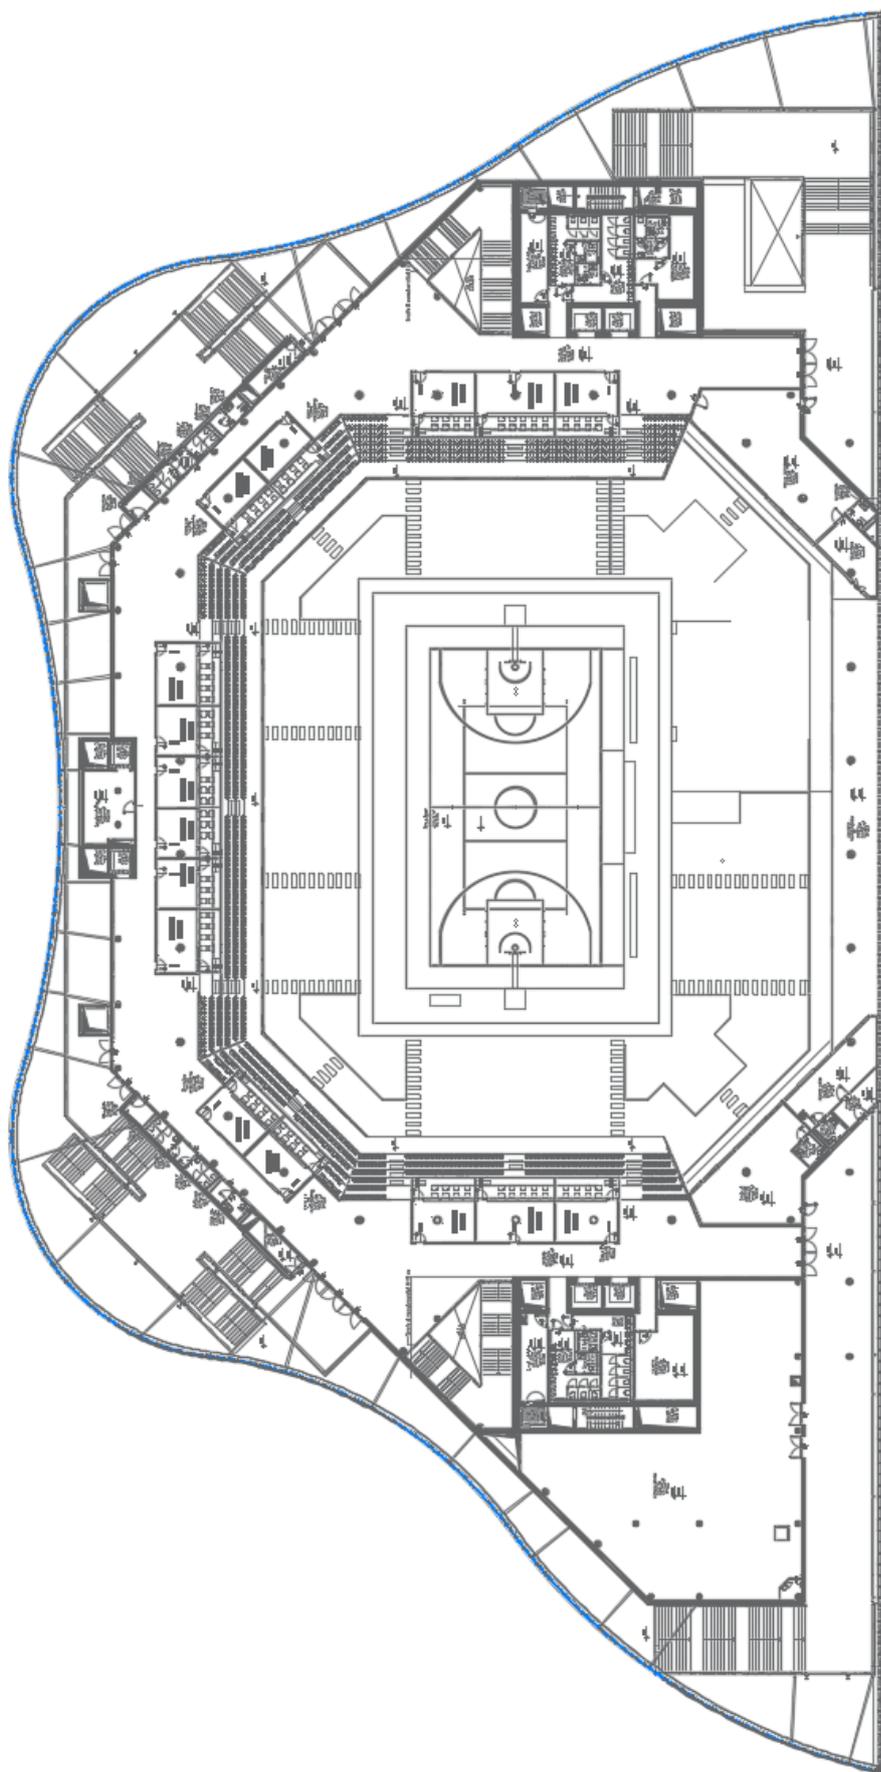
Pianta piano secondo (Fonte: Studio GAe Engineering)
